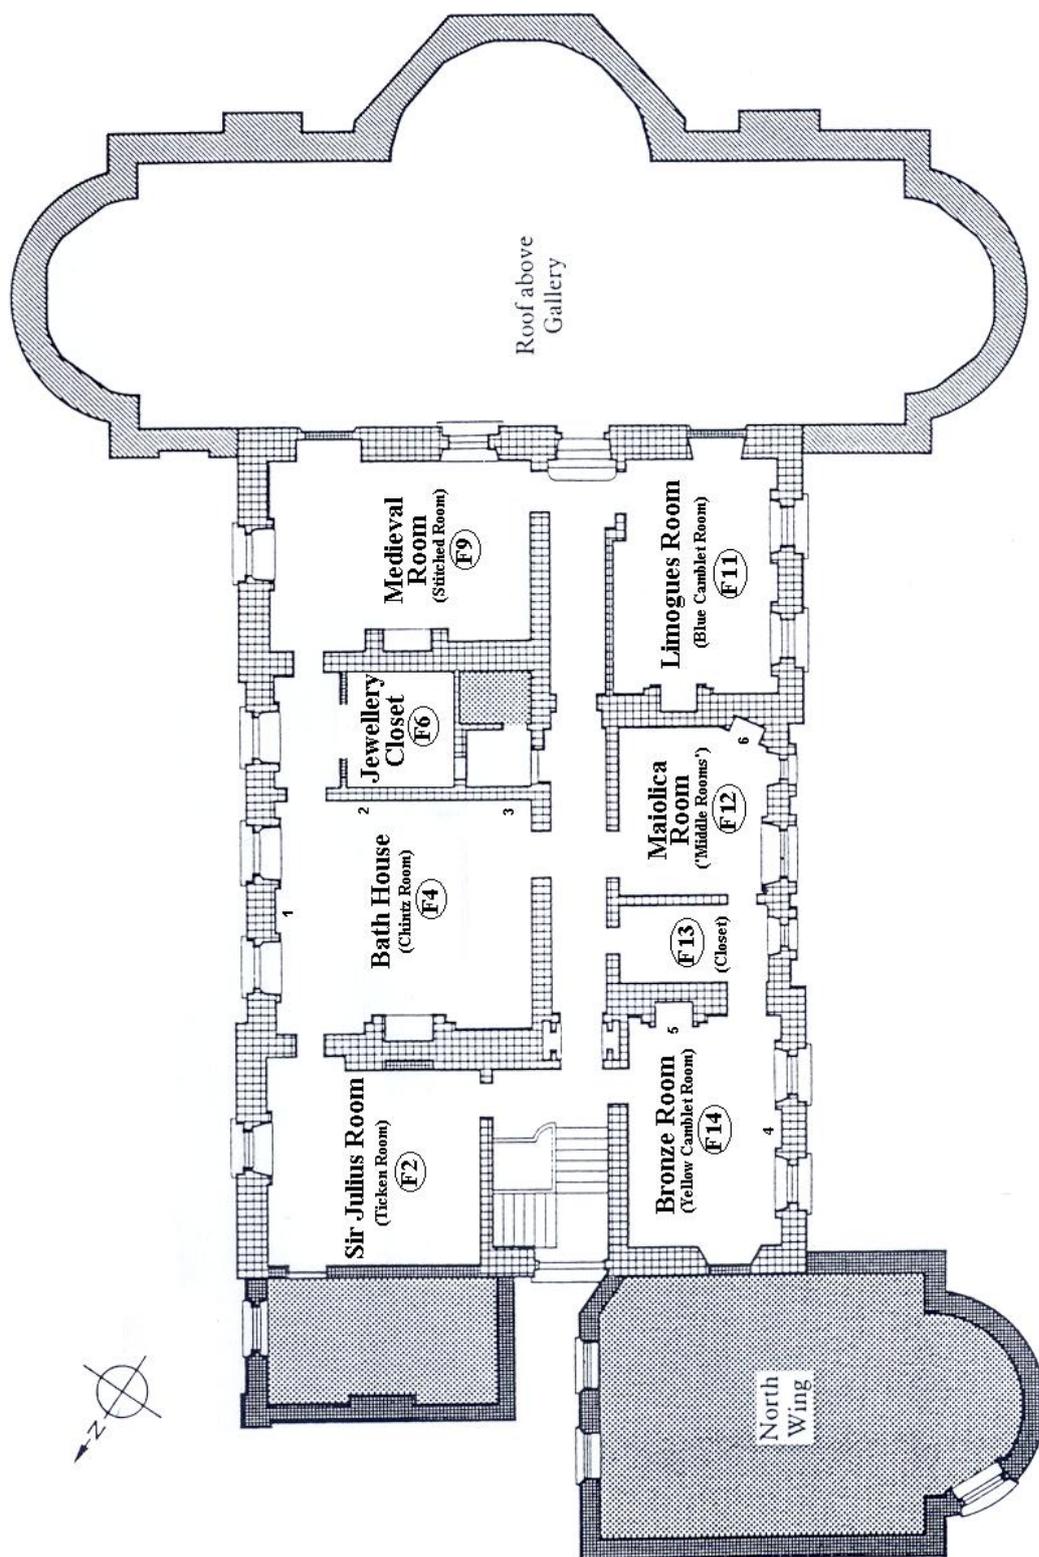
Planta de Kenwood House House, rés-do-chão, com os pontos de medição para o plano de luz.
